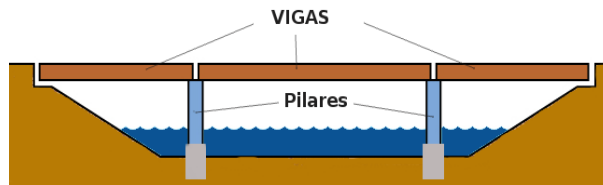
Vista de las vigas de un puente de tres tramos (Fuente Wikipedia)
